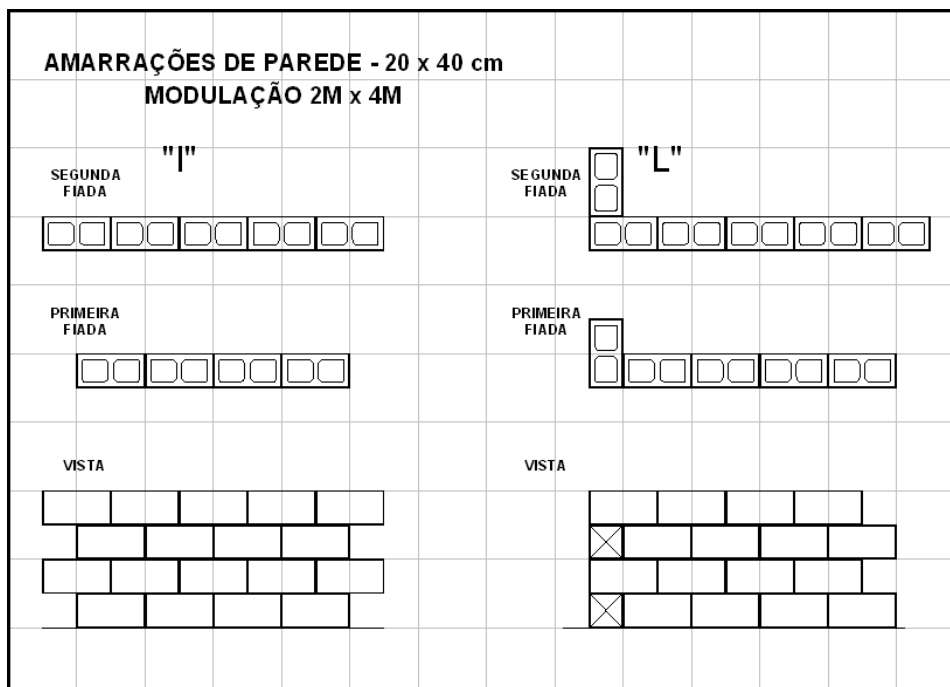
Modulação 2M x 4M. Amarrações de parede “I” e “L”
